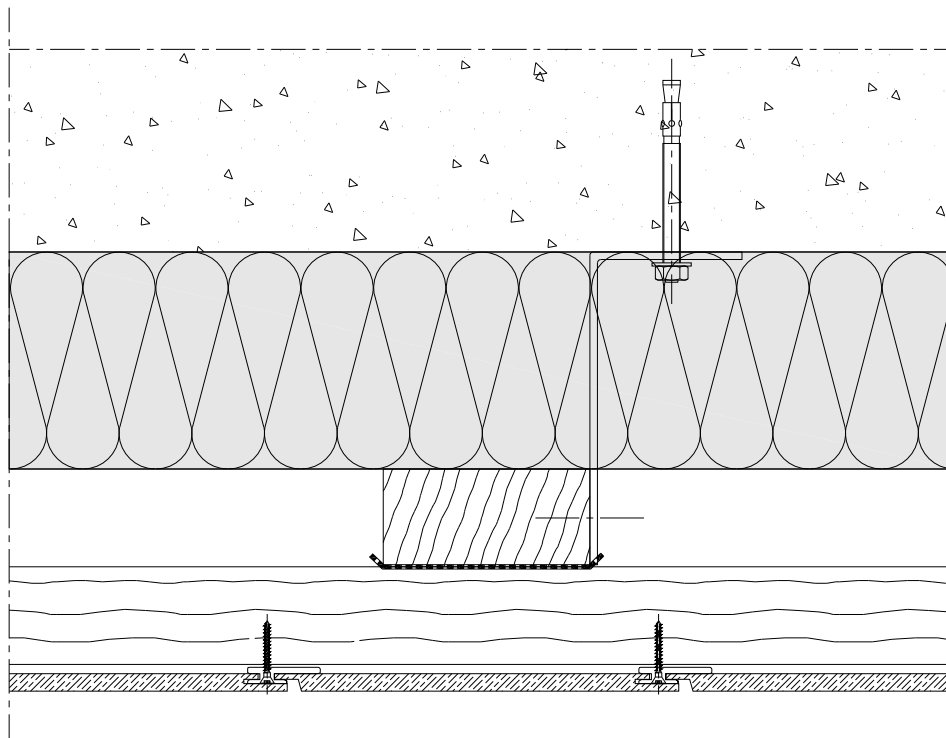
Pose verticale - Joint vertical (coupe horizontale)
